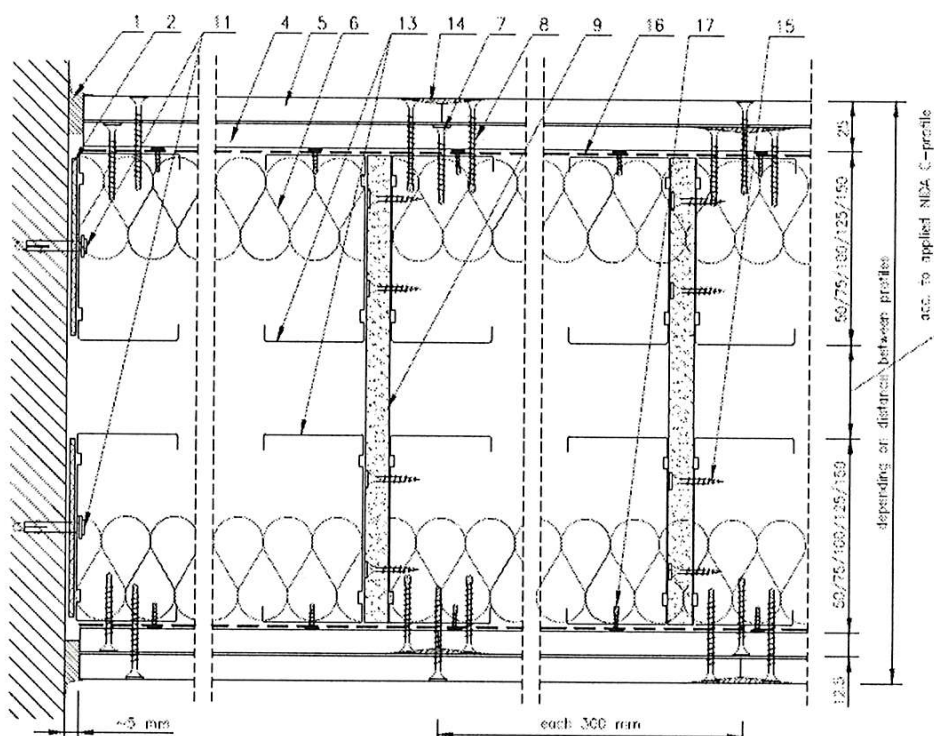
Vertikal- und Horizontalschnitt von einbruchshemmenden nichttragenden zweilagigen Trennwänden mit doppeltem Ständerwerk + 1mm Stahlblech (beidseitig) – für Installationswände.
